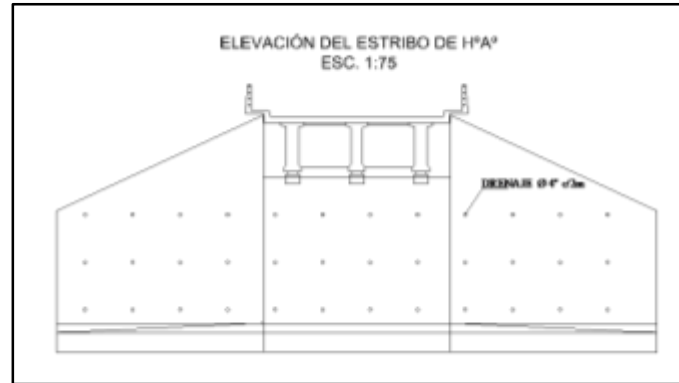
Elevación del Estribo Tipo (fuente elaboración propia)
